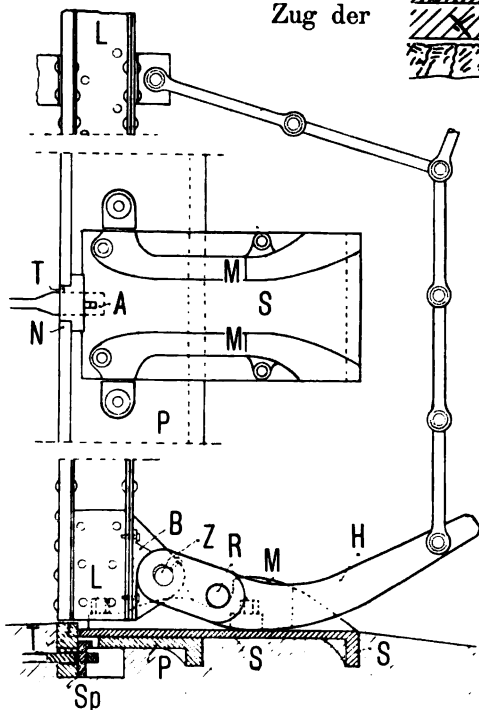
Klinkvorrichtung am Pretziener Wehr.
